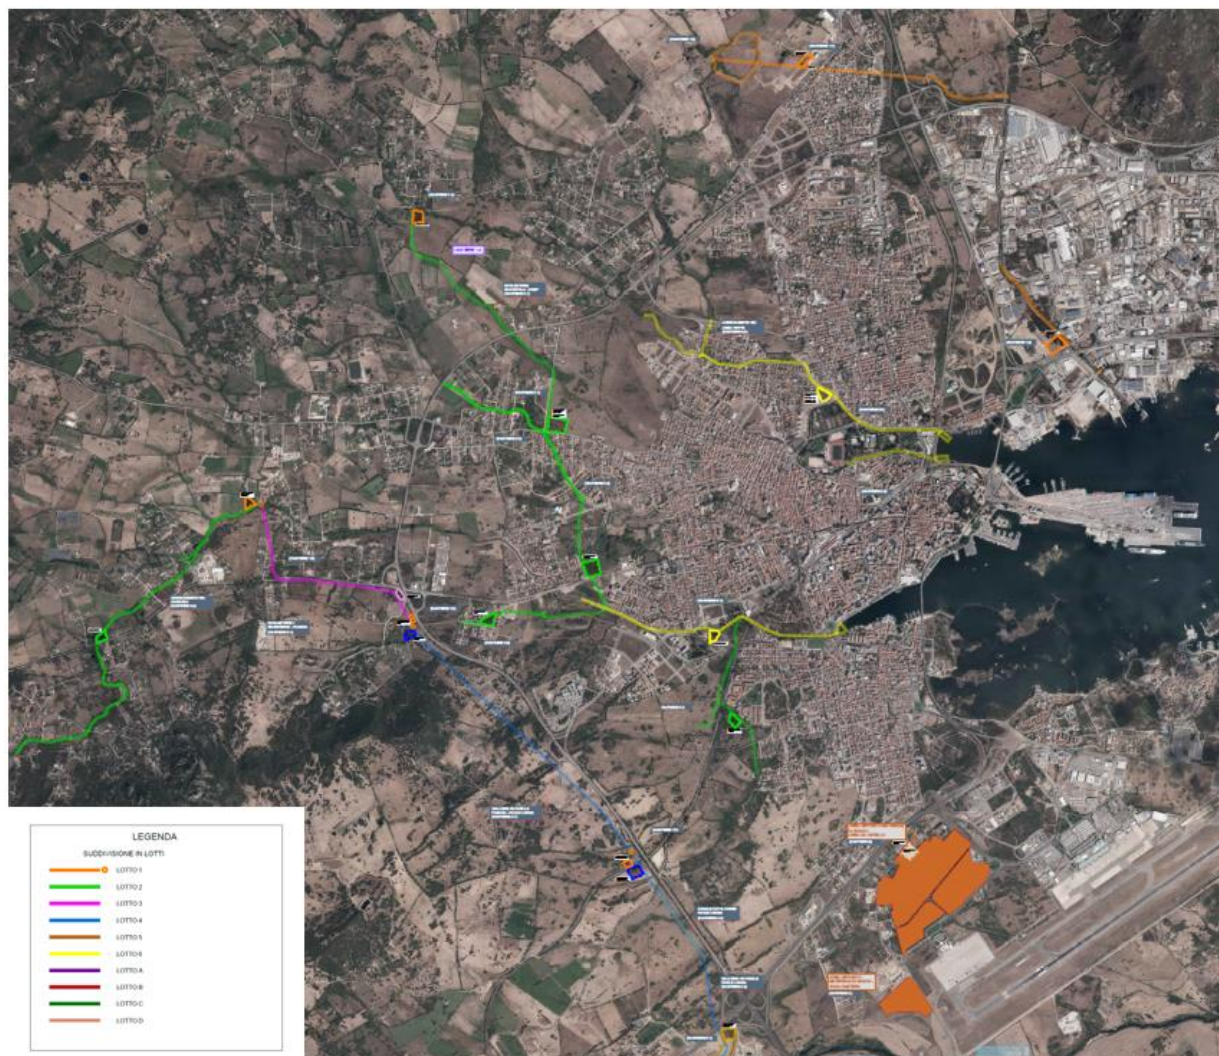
Ubicazione planimetrica dei lotti in cui sono articolate le opere del progetto
